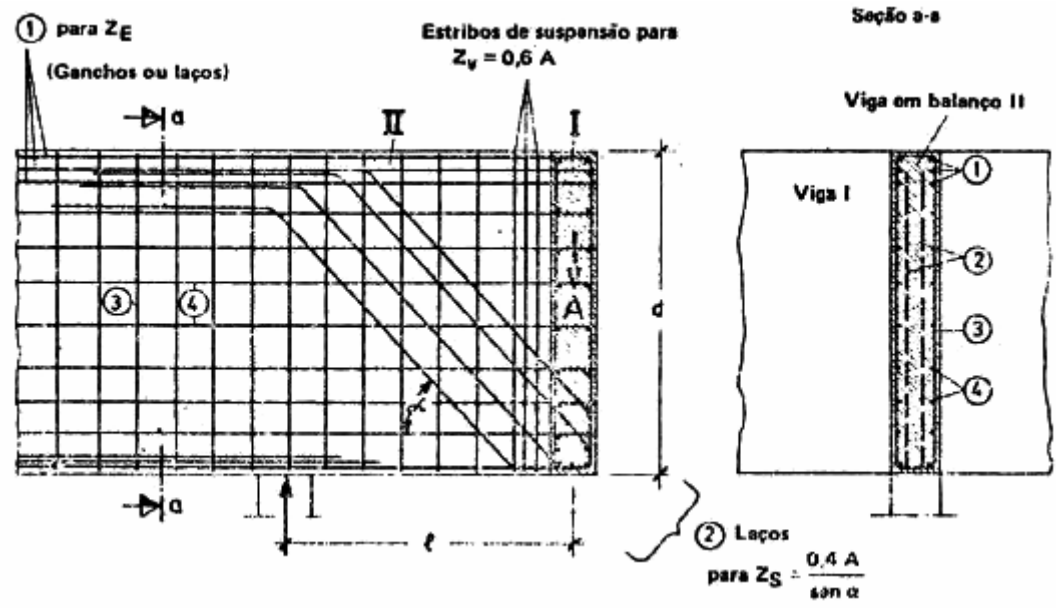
Apoio indirecto de parede em consola – Pormenor das armaduras
